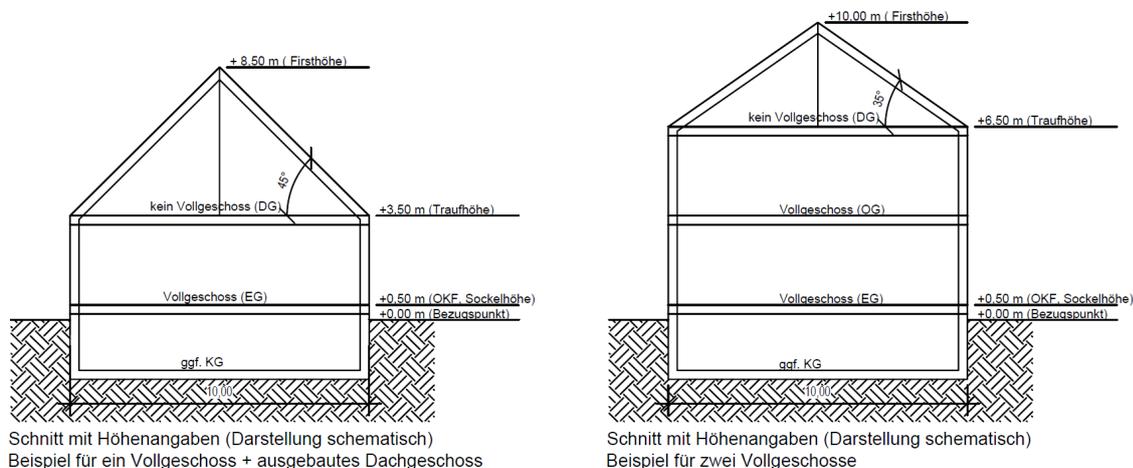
Beispielhafte Gebäudeschnitte in ein- und zweigeschossiger Bauweise
